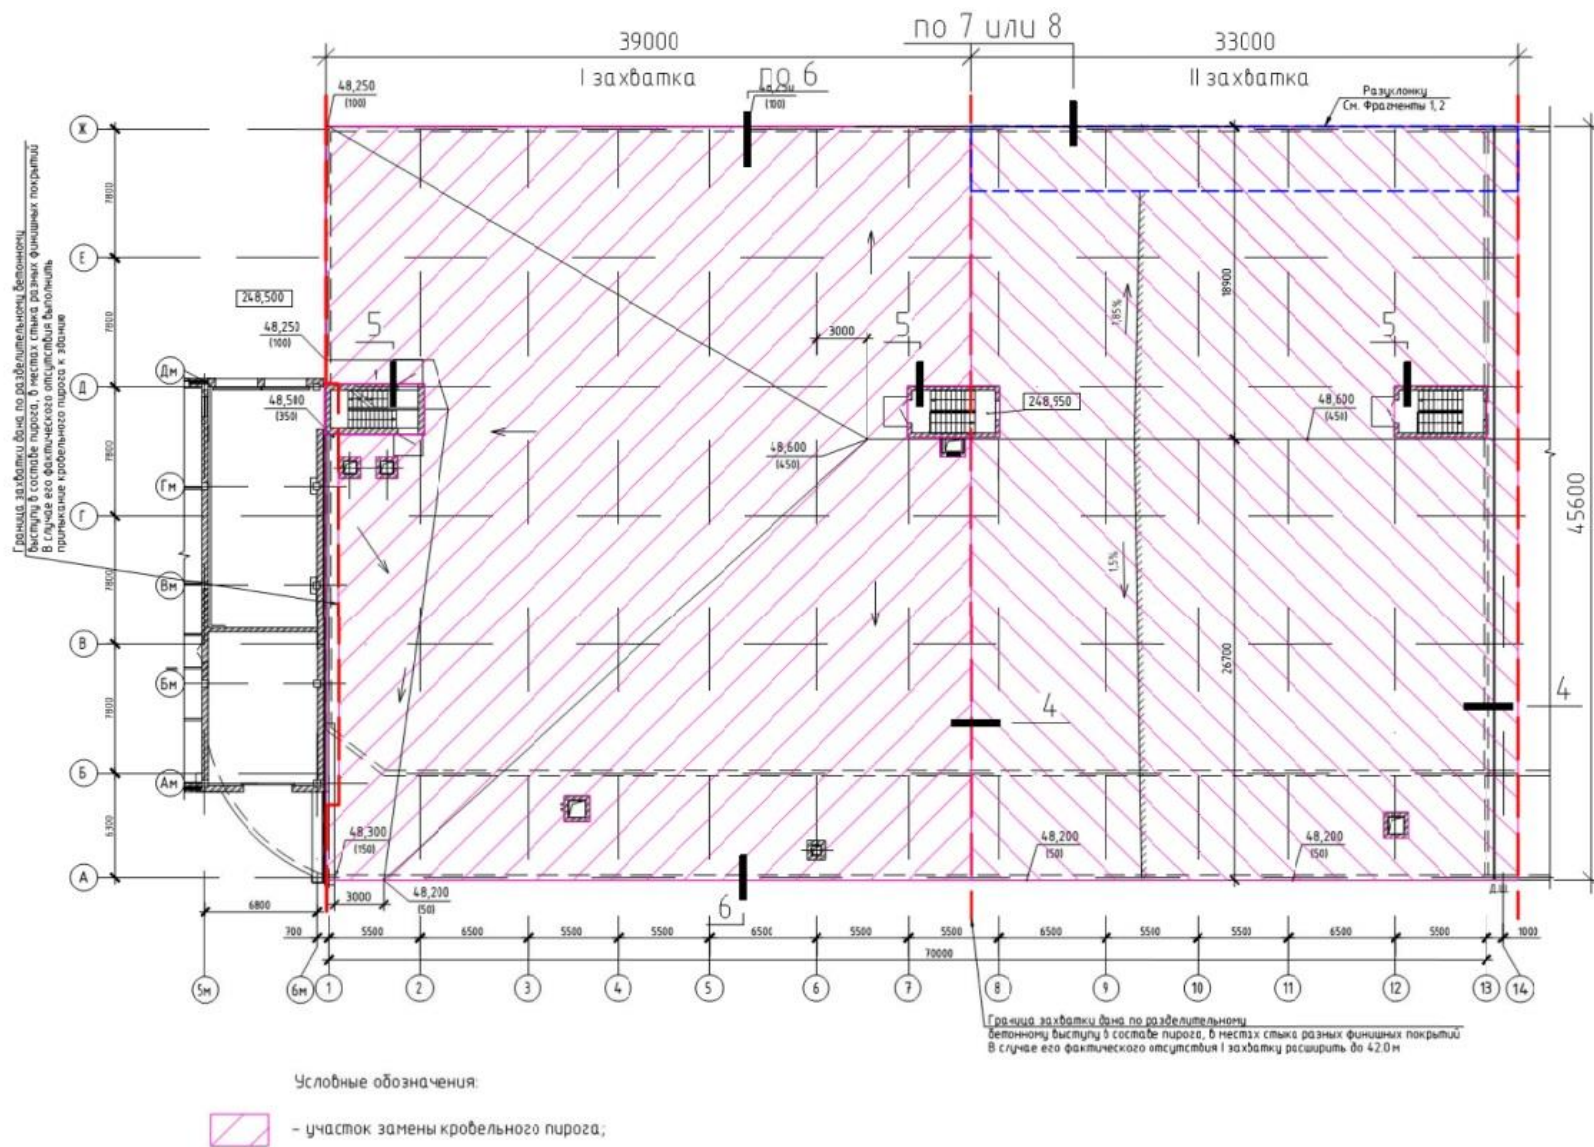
Вариант №2. Схема участков замены кровли.
